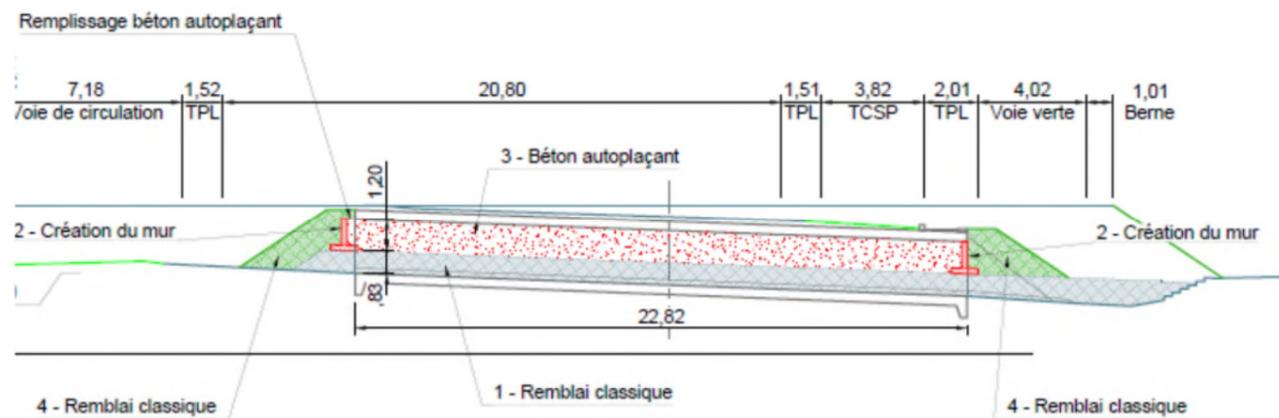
PLAN DU PASSAGE INFÉRIEUR EXISTANT DES PLAINES
